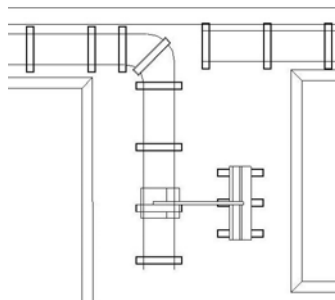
Střešní vozík RE-3d firmy Roof Elevators
